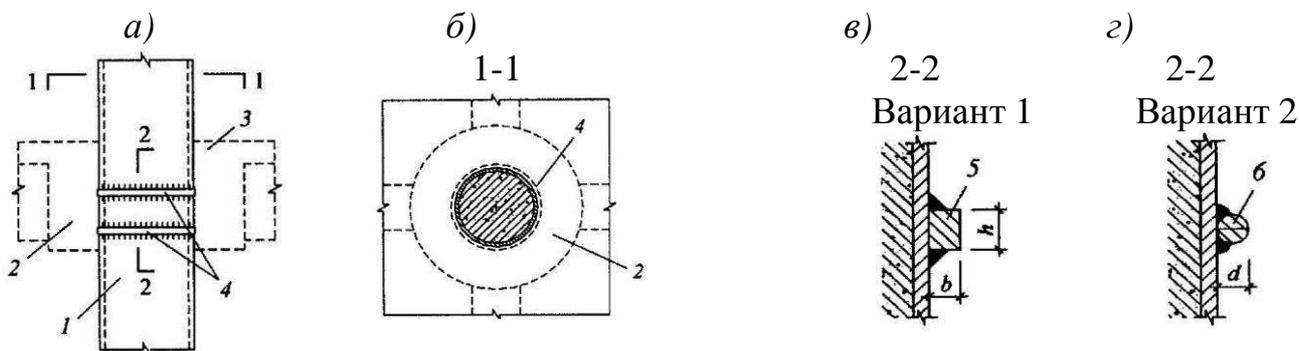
Узел кольцевого соединения между сталежелезобетонной колонной и железобетонными балками при помощи контурного кольцевого соединения: *а* – вид узла соединения сбоку; *б* – узел в плане по сечению 1-1; *в, г* – варианты устройства кольцевой опоры; 1 – сталежелезобетонная колонна с жестким армированием из стальной трубы; 2 – железобетонные кольцевые балки; 3 – железобетонное перекрытие; 4 – стальные кольца для восприятия срезающей, поперечной силы; 5 – полосовая сталь; 6 – круглая сталь
